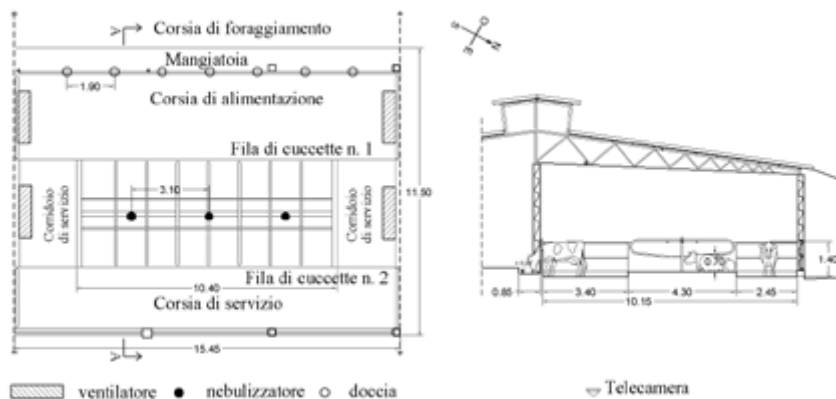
Pianta e sezione dell'area della stalla in cui è stata svolta la prova.
